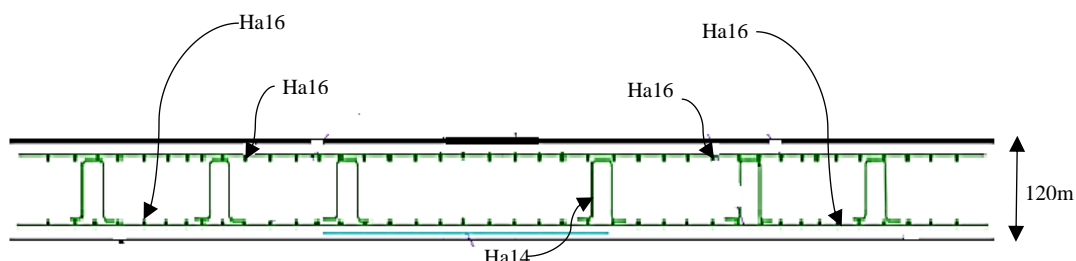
Ferrailage de la dalle du radier du Bloc A et le Bloc B.
